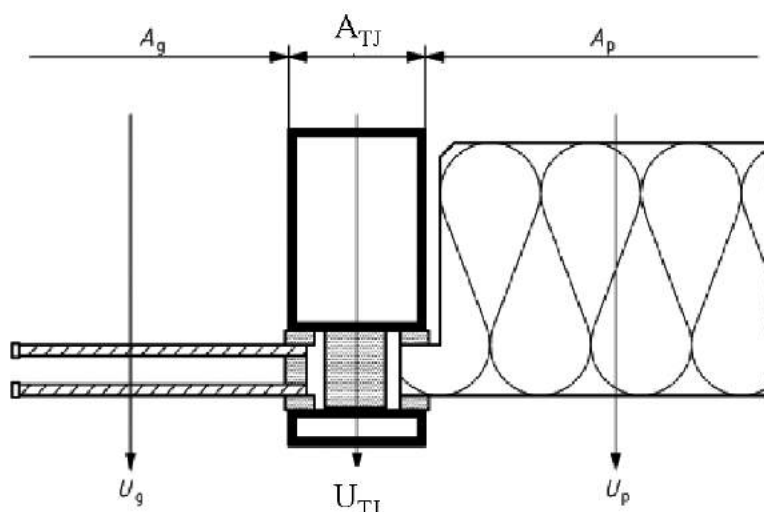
Als ein Fassadenelement betrachtete Verbindung mit eigener Fläche
